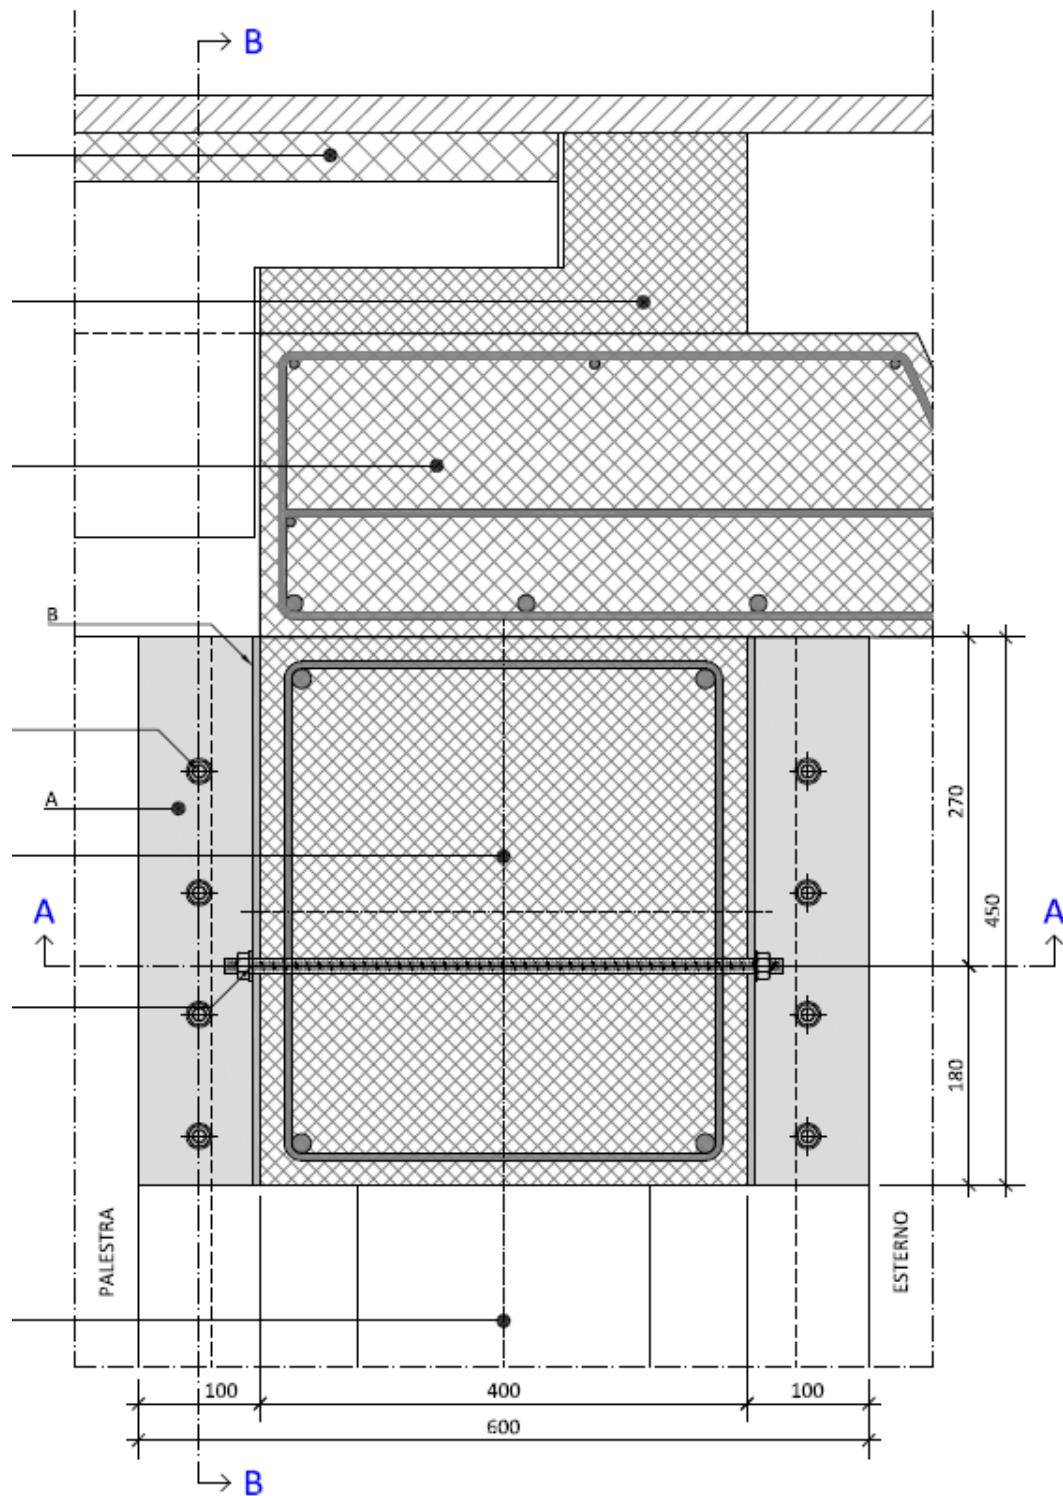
Intervento 02c – Sezione ortogonale al piano della trave
